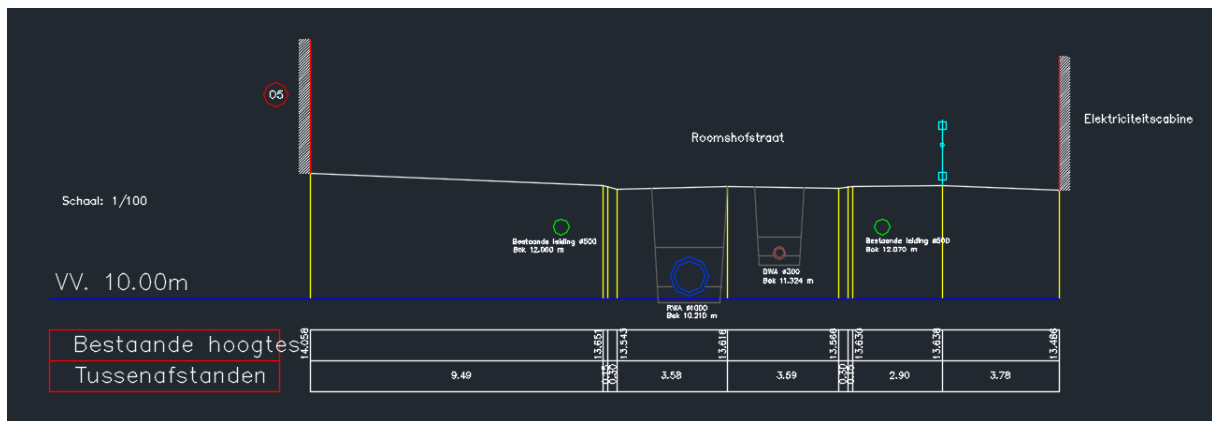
Opbouw van de straatniveaus en voetpaden Keppestraat en Roomshofstraat (stad Aalst).
